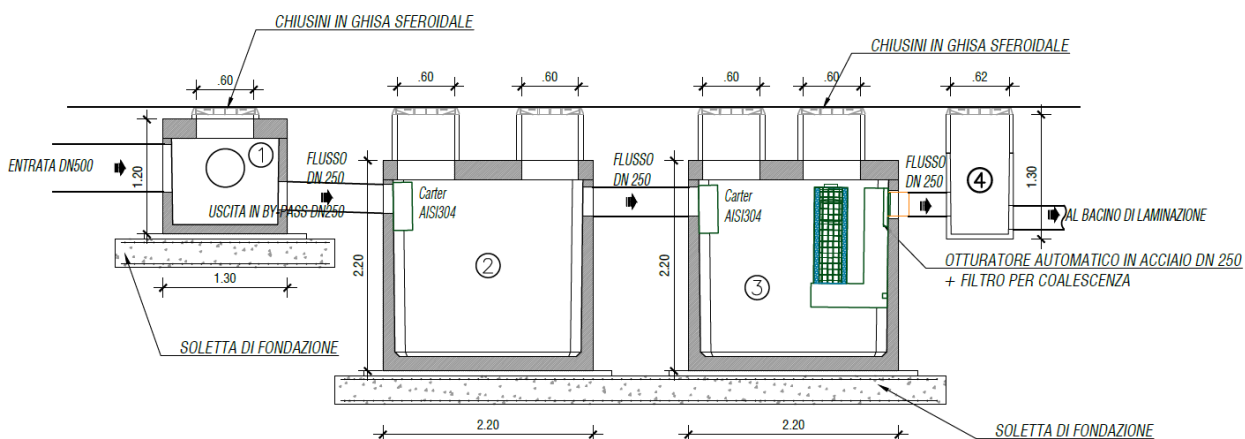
Sezione tipo – Impianto di trattamento AMPP
